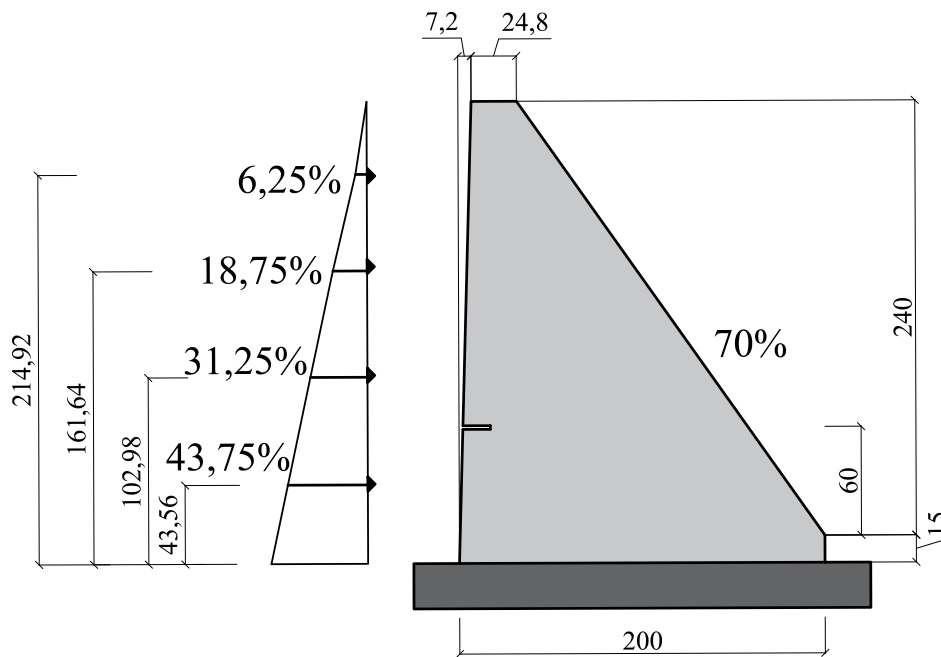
Barragem: condições de contorno e geometria (dimensões em mm).
